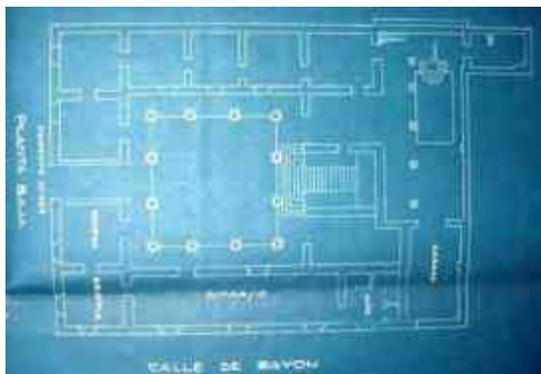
Planimetría de la casa habitación del cura Juan Bruno de Luna, como Guarnición Militar, planta baja.
